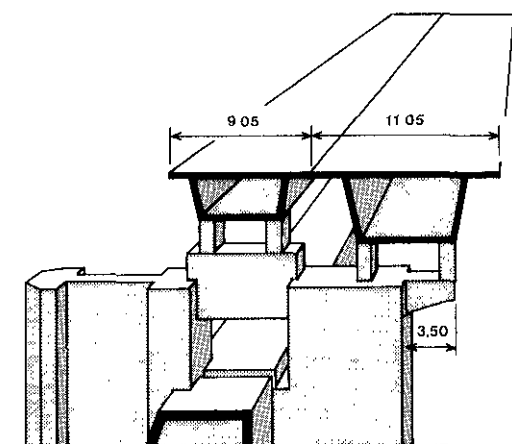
De alternatieve voorzieningen aan de pijlers voor de stormvloedkering
